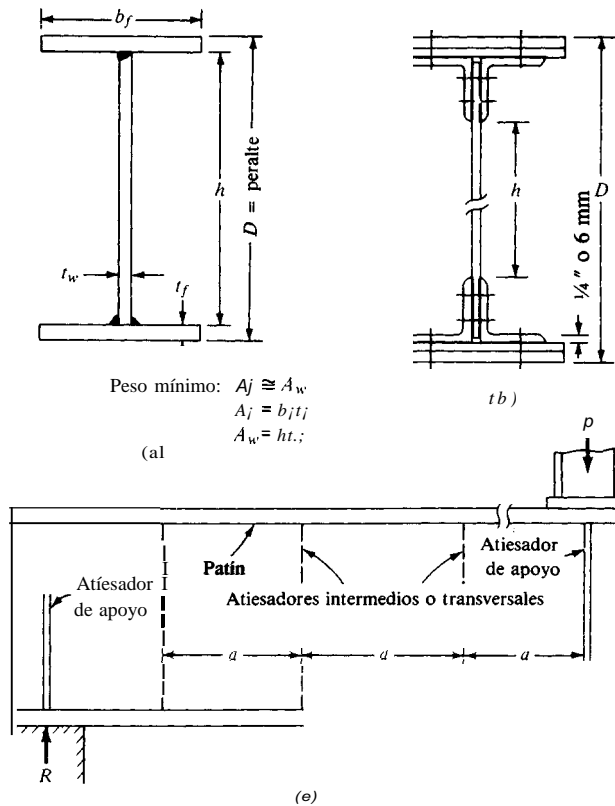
Croquis y detalles de las trabes armadas. Nótese la definición del peralte D y la distancia libre h . La relación h/t_w constituye un parámetro significativo en el diseño de las trabes armadas. (a) Trabe armada soldada. (b) Viga armada remachada o atornillada. (c) Elevación de la trabe (vista lateral) ilustrando otros elementos del diseño,
